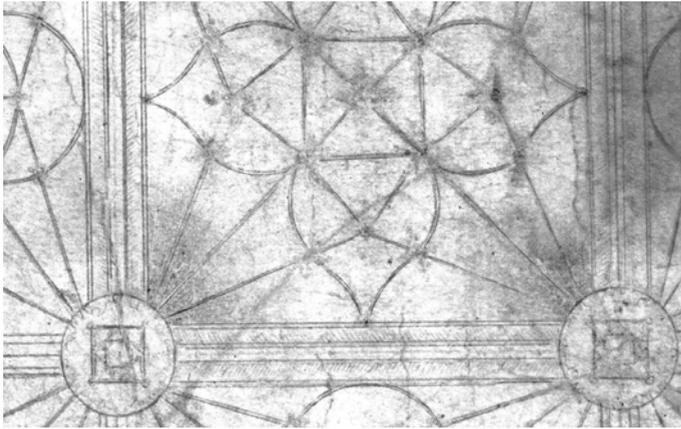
Pilar en el plano de la catedral de Segovia.
